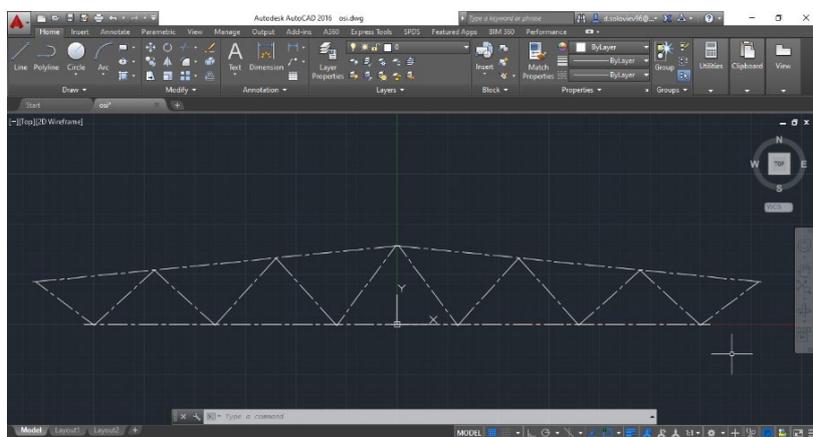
Опорная модель стропильной фермы в AutoCAD
